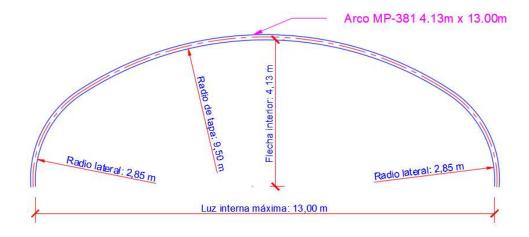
Sección de arco metálico propuesta 13.00mx 4.13m. Fuente: Plano P1, elaboración propia
